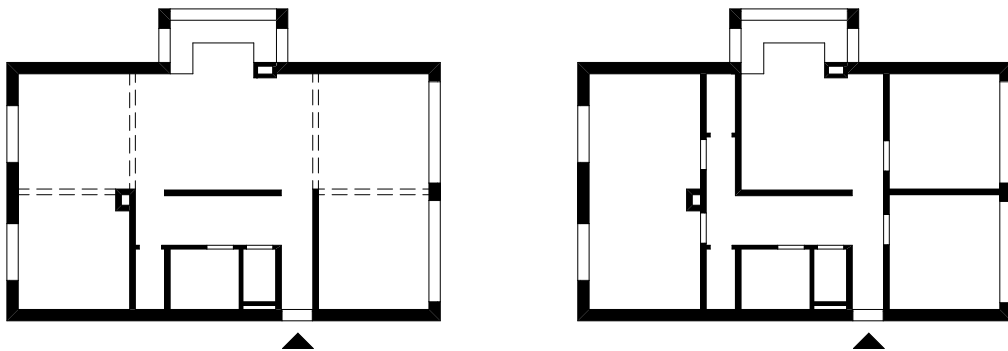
Grundrissvarianten, M 1:200,
